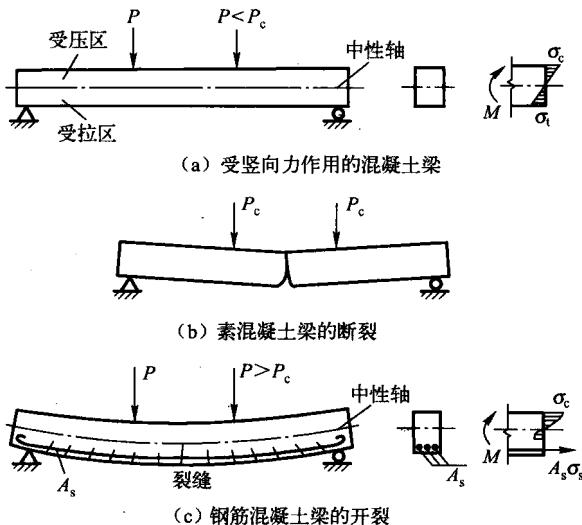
素混凝土梁和钢筋混凝土梁的受力性能比较
